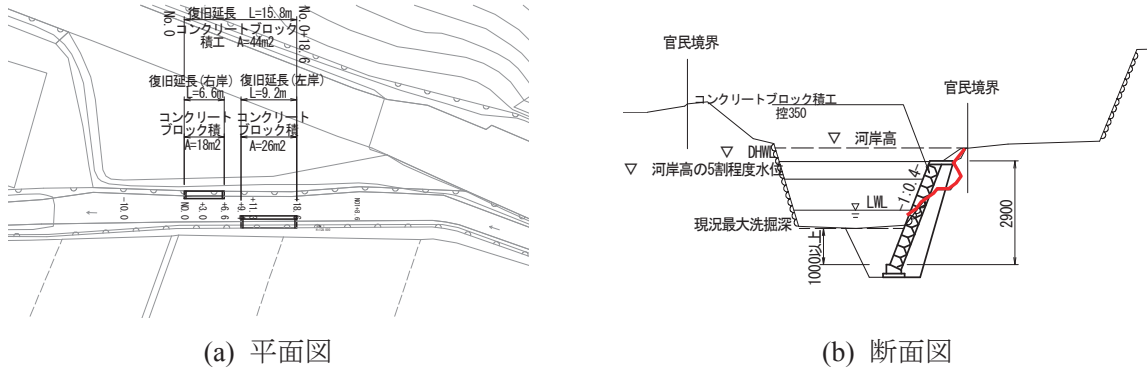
護岸の平面図と横断面図 (No.6 右岸)
